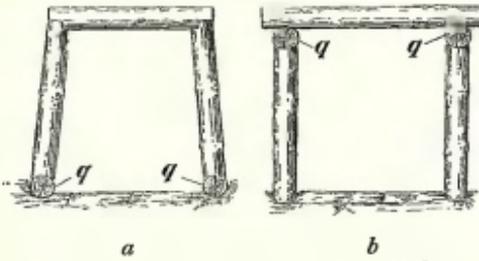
Türstockzimmerung mit Quetschhölzern.
